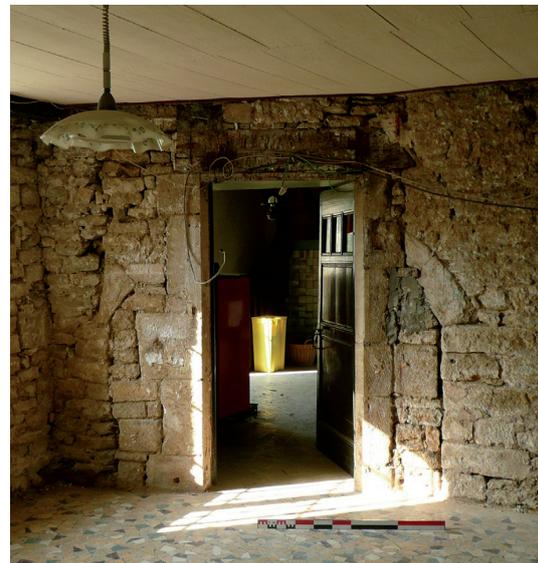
tour porche, façade nord, rez-de-chaussée intérieur, porte d'accès depuis le logis (cl. A. P.)
